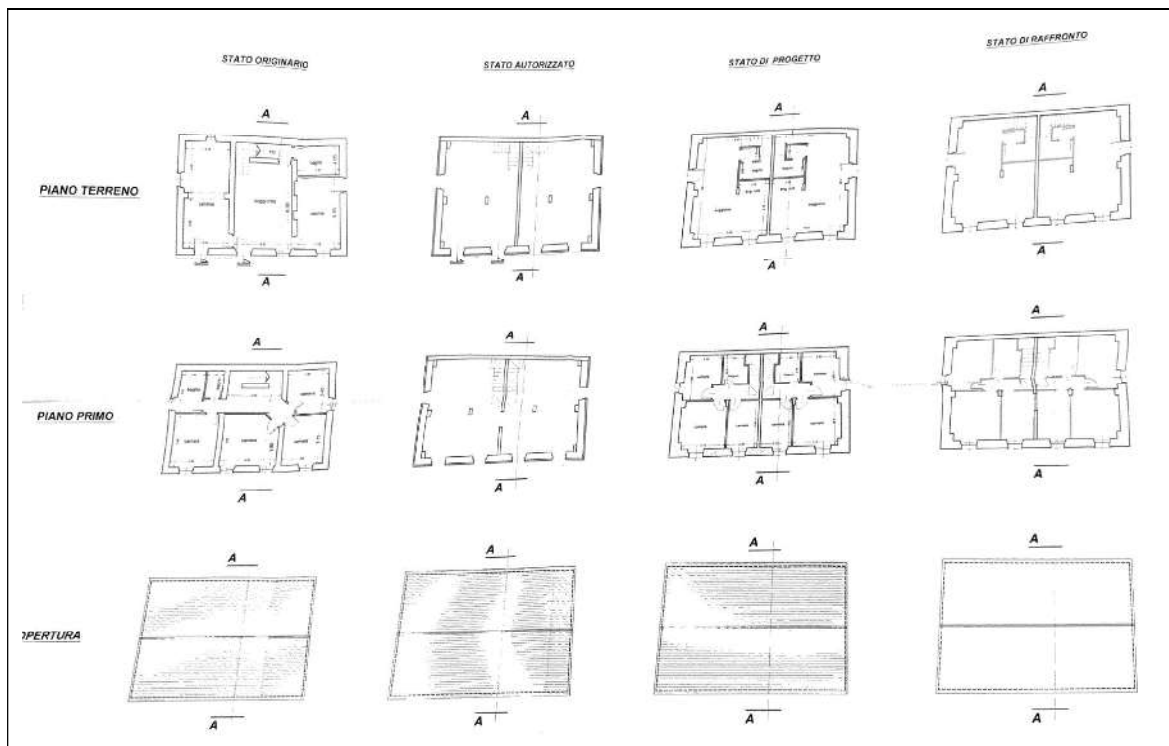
Stato di progetto approvato AP 32/2012 FABBRICATO 2
